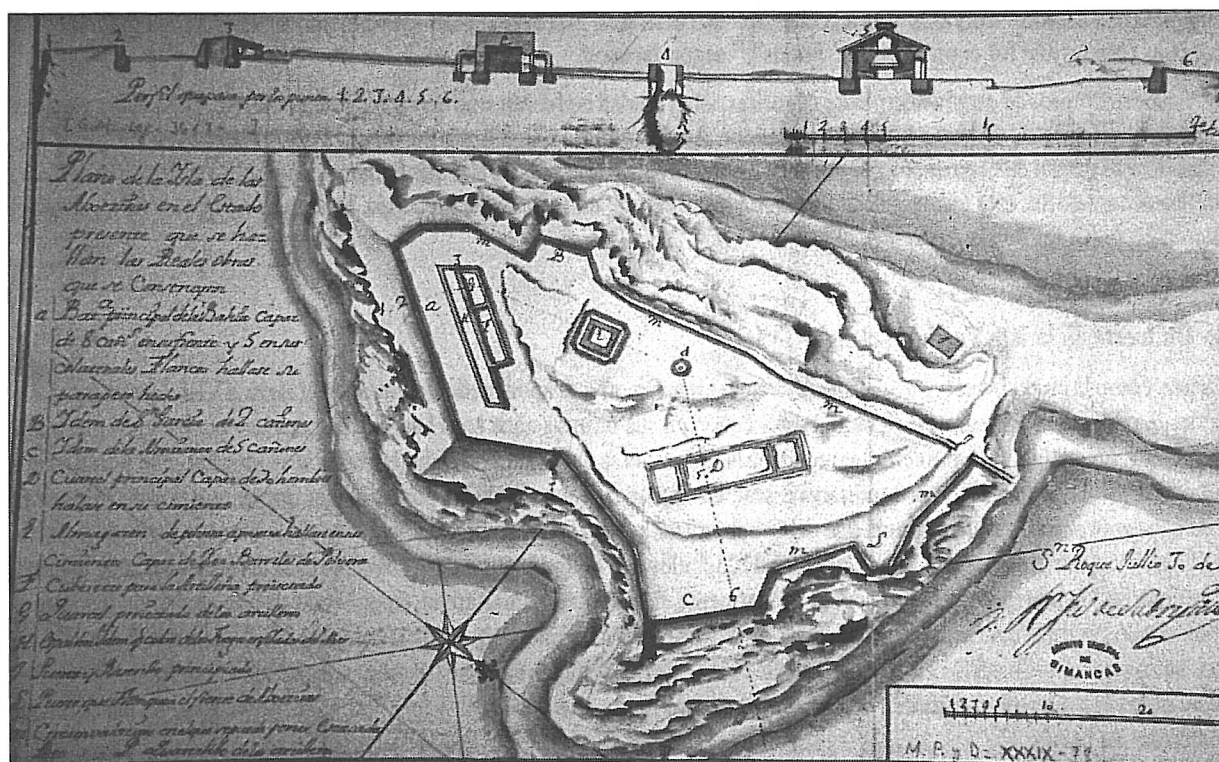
Plano de Simancas con planta y sección. Proyecto respecto al que se construye el fuerte: "Plano de la Isla de las Algeiras en el Estado presente que se hallan las Reales Obras que se construyen", por Juan de Subreville, San Roque, 30 de julio de 1734. A.G.S., M.P. y D. - XXXIX-78, G.M., leg 3.618, escala 1:576.
